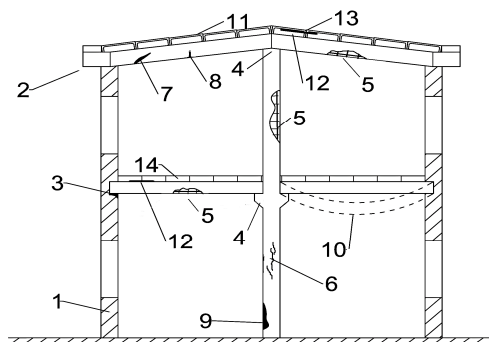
Характерные повреждения несущих конструкций здания: 1 – повреждение цокольной части стен; 2 – повреждение карнизной части стен; 3 – трещины в кладке под опорой ригеля; 4 – повреждение опорной части ригеля или консоли колонны; 5 – оголение и коррозия арматуры; 6 – продольные трещины в колонне; 7 – наклонные трещины в ригеле; 8 – нормальные трещины в ригеле; 9 – механическое повреждение бетона колонн (ригелей, рёбер плит и полок плит; 10 – чрезмерные прогибы; 11 – повреждения опорных участков плит; 12 – следы протечек кровли или водонесущих коммуникаций; 13 – повреждения кровли; 14 – трещины в плитах или большие прогибы
